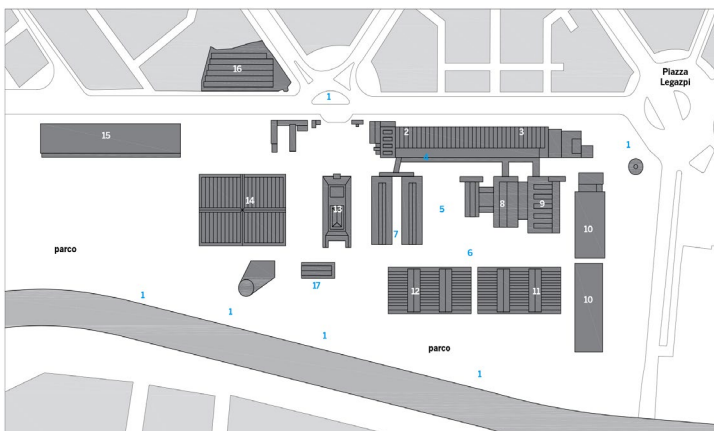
Planimetria generale. Arketipo 77, settembre 2013\_p.122
